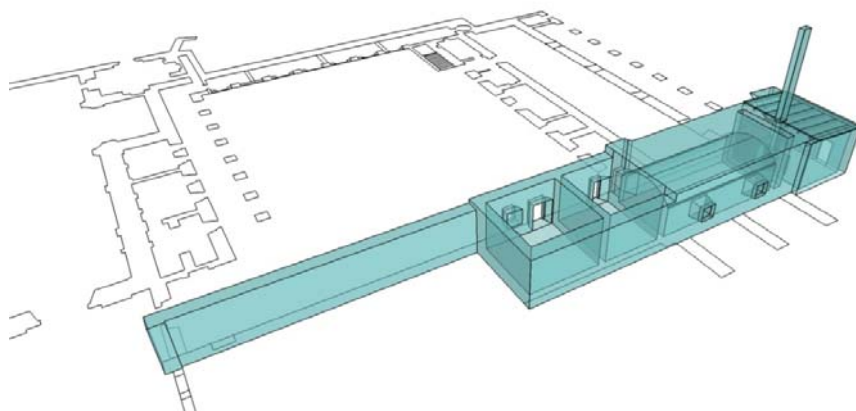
Reconstrucción Virtual Sector 4 a: Ala Este Planta Baja.
